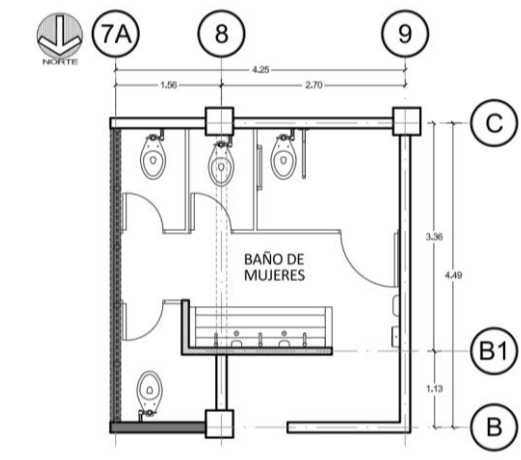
Planta Arquitectónica Módulo Sanitarios de Mujeres, Primer Nivel
